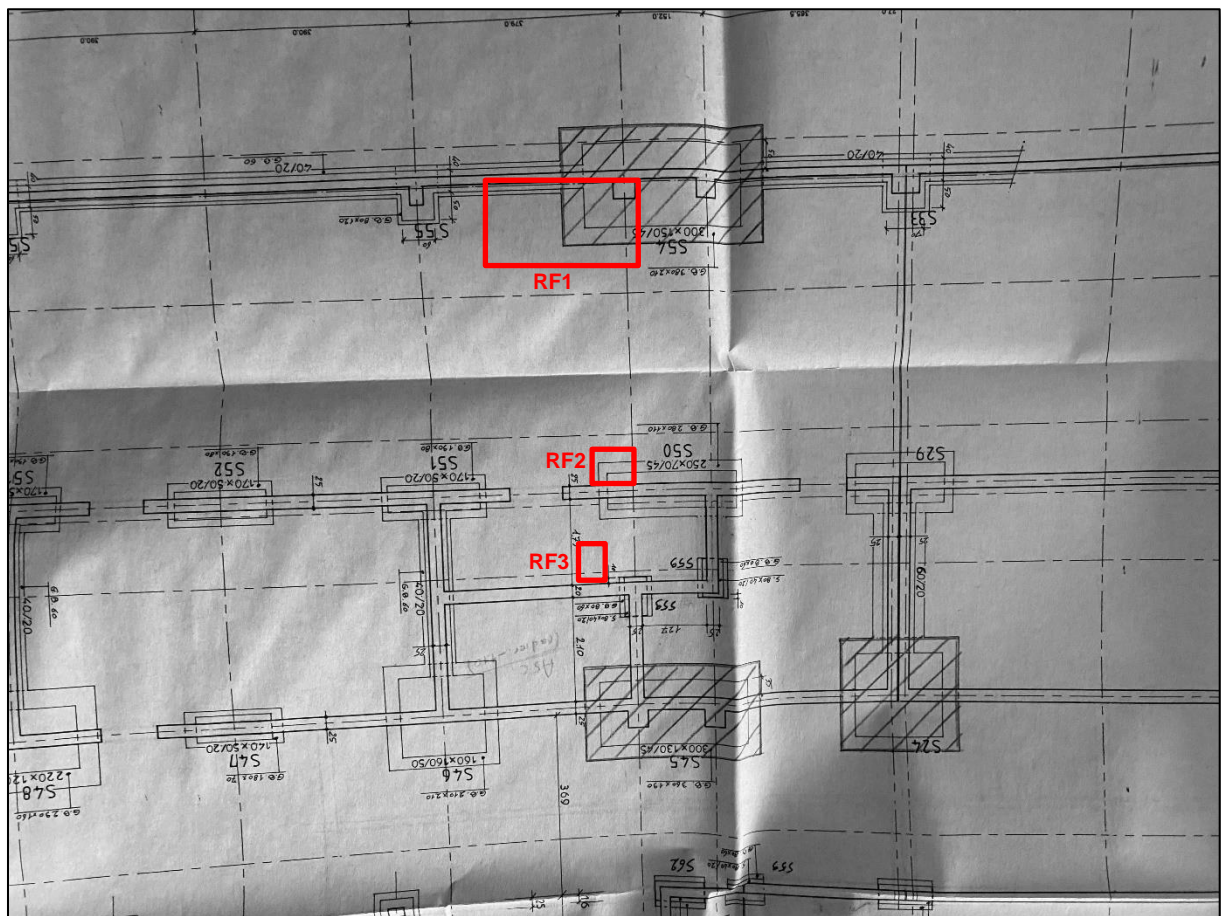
Implantation des sondages et essais géotechniques sur fond de plan de coffrage des fondations
